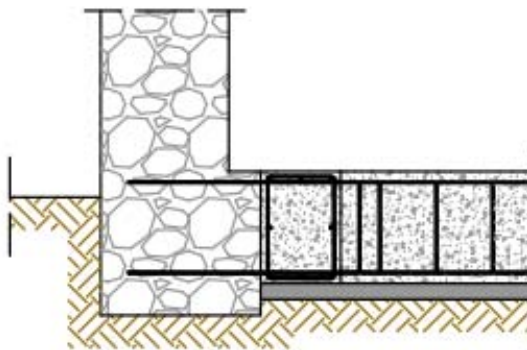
Sección zapata corrida bajo muro medianero. Refuerzo 2. Fuente propia.
